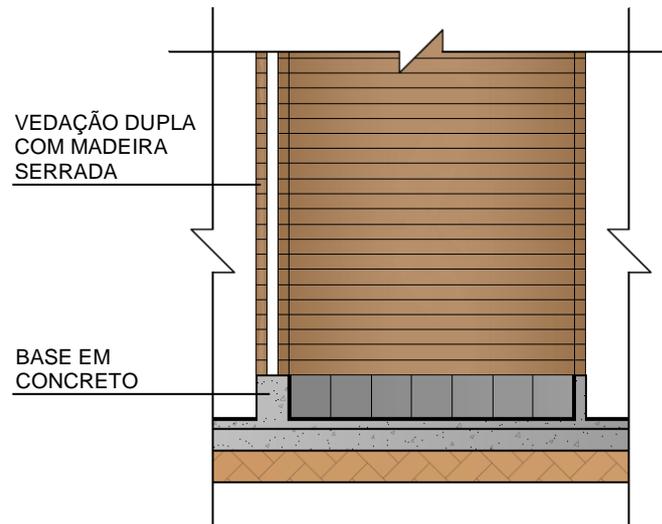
Planta baixa demonstrando, em marrom, as peças de madeira serrada para a vedação do banheiro e da cozinha
